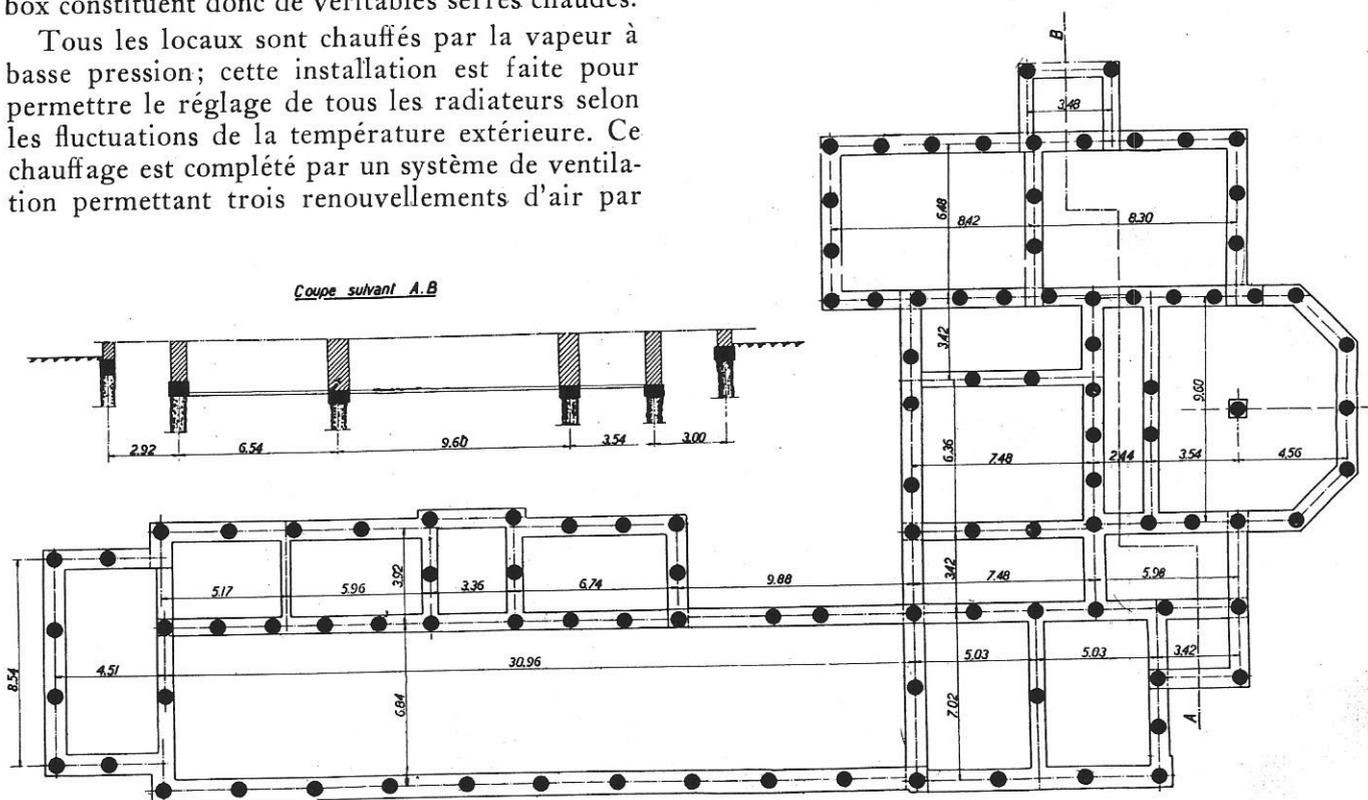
Plan des fondations (108 pieux Franki de 6 m).
